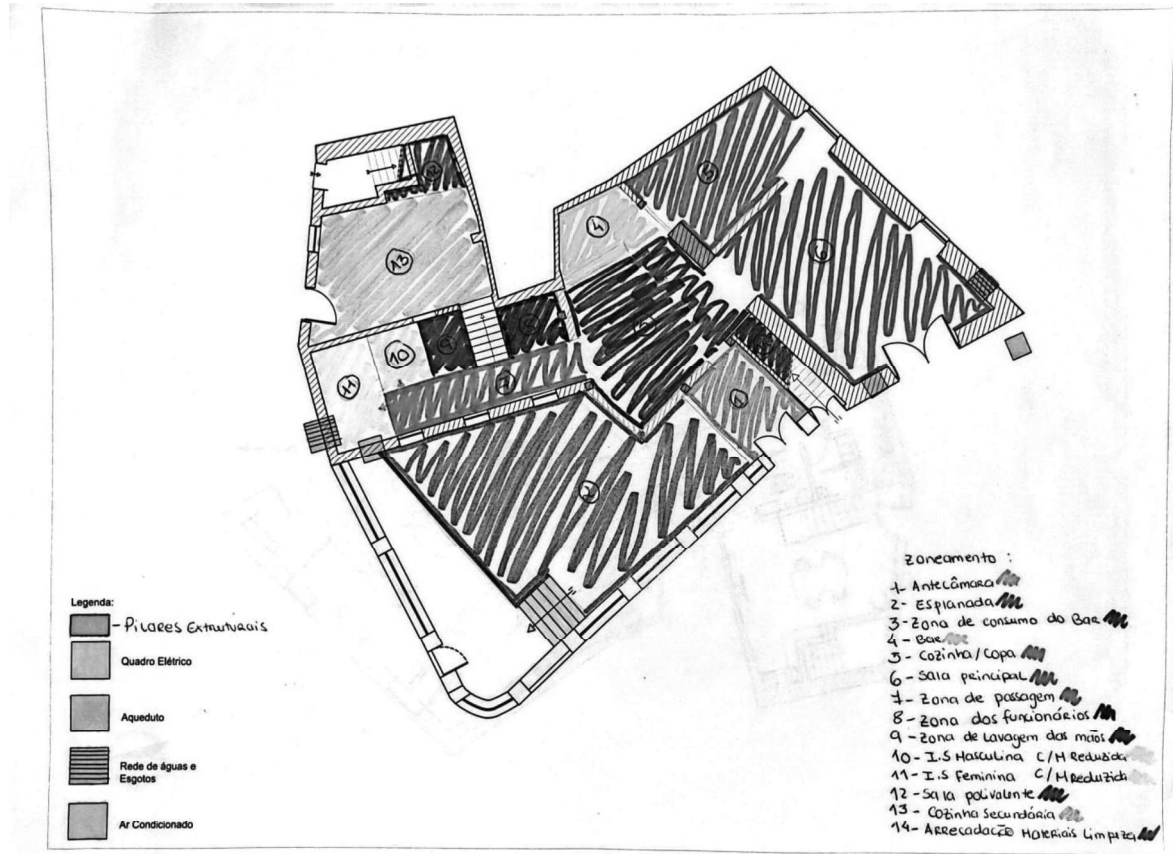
Planta de zonamentos 1. Fonte: o Autor.
